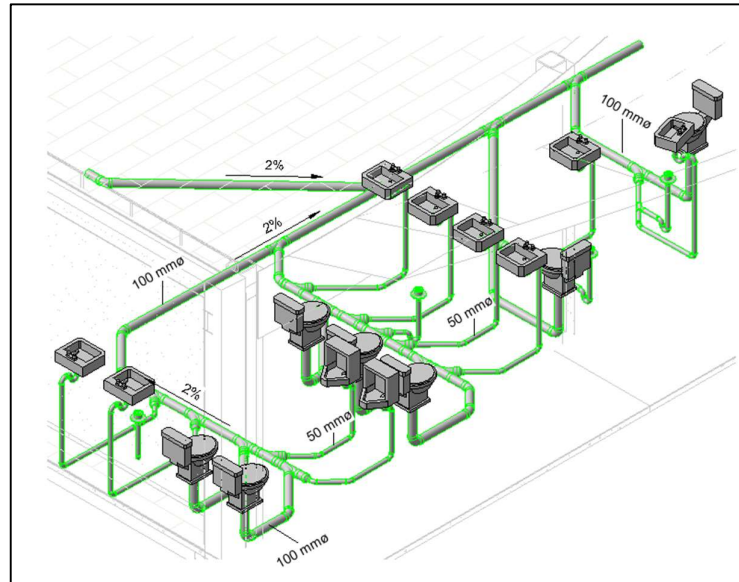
Aplicación plantilla de vista para alcantarillado
